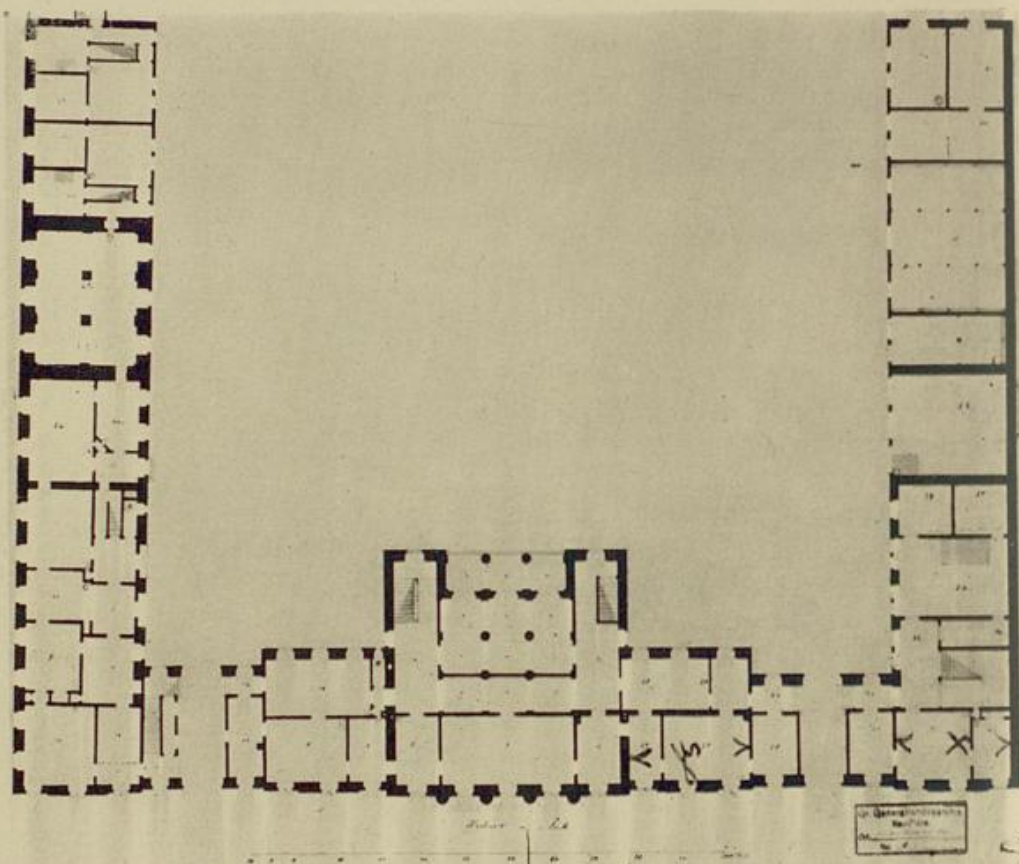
Grundriß des Staatsministeriums. Erdgeschoß
